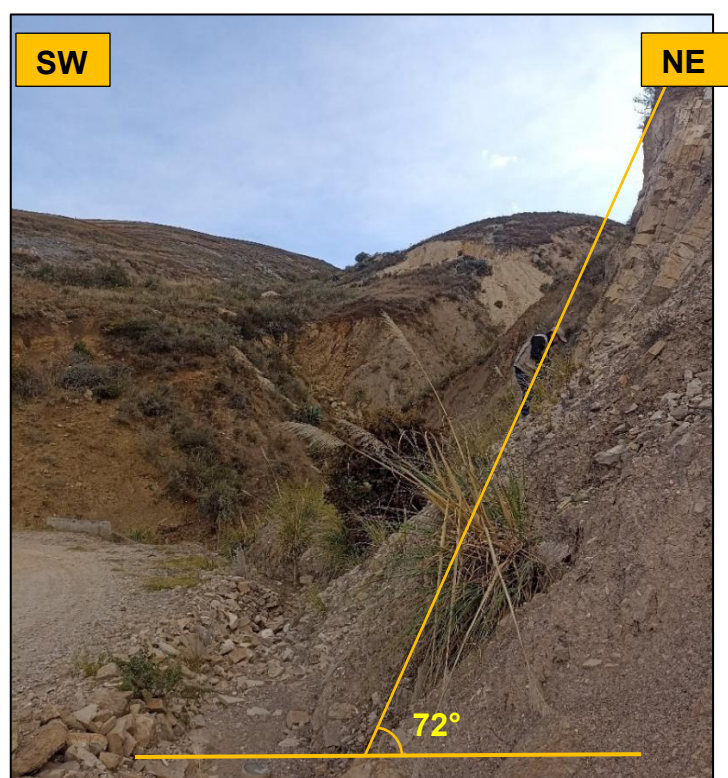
Perfil del talud en la progresiva Km 6 + 300.
